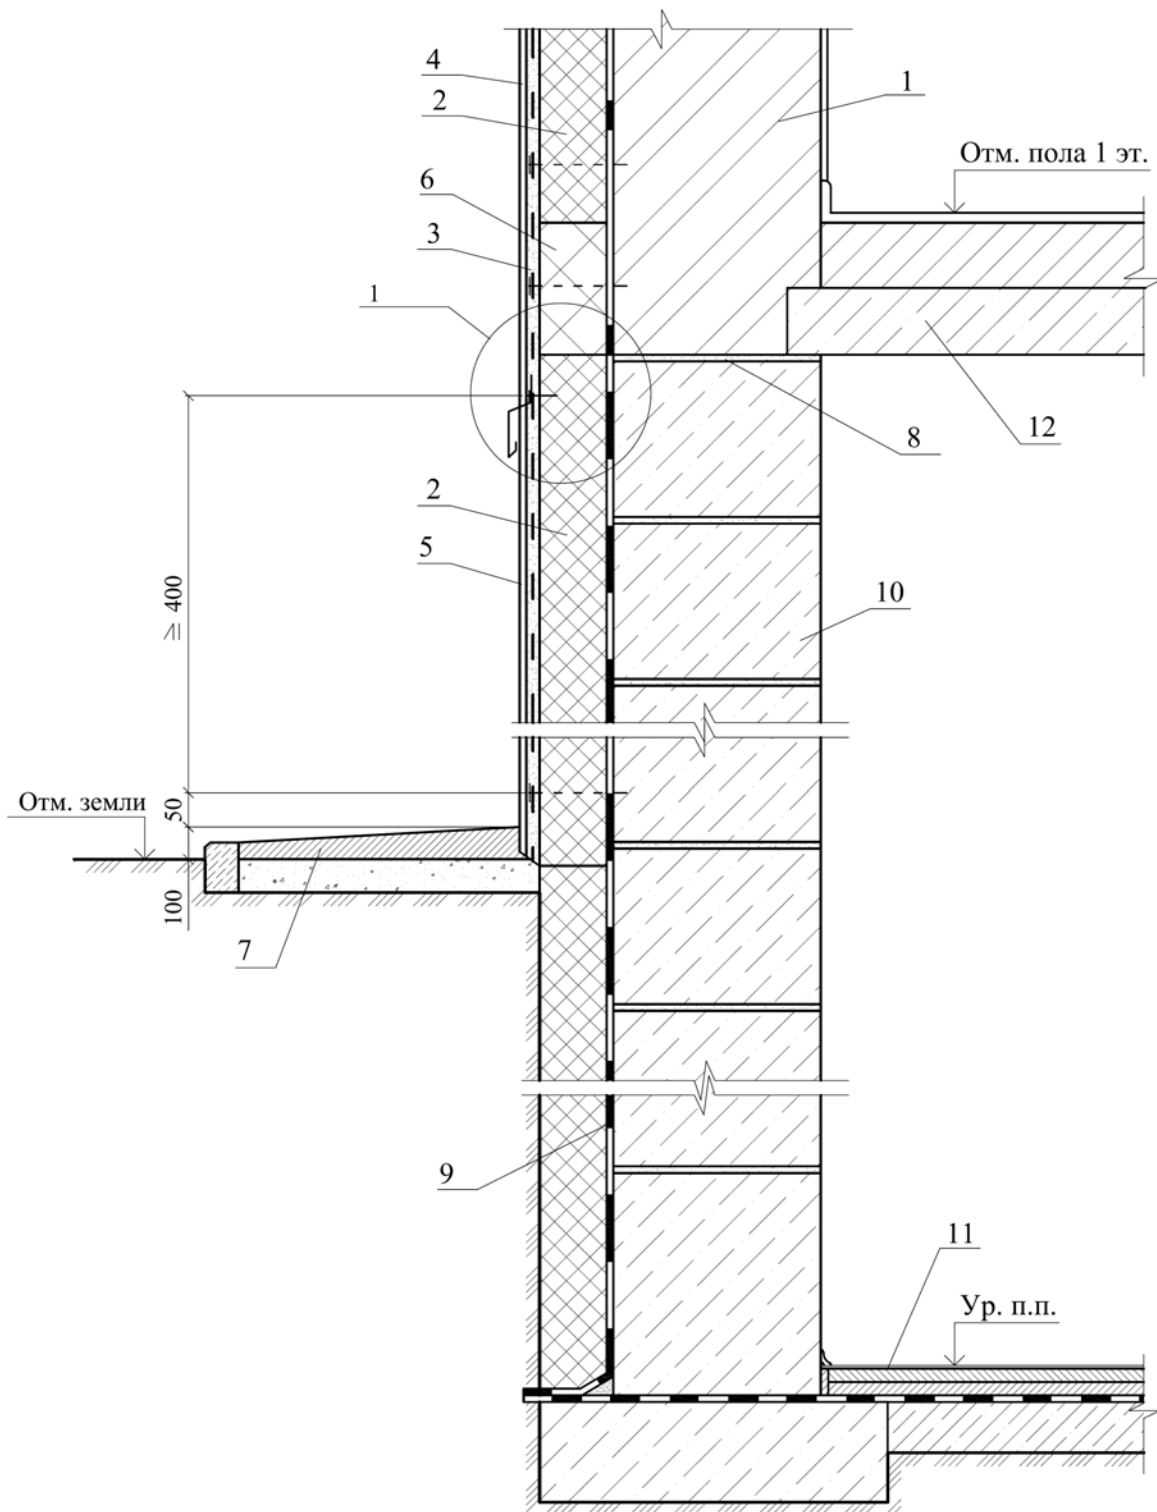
Стена подвала с теплоизоляцией плитами из экструзионного пенополистирола с наружной стороны
